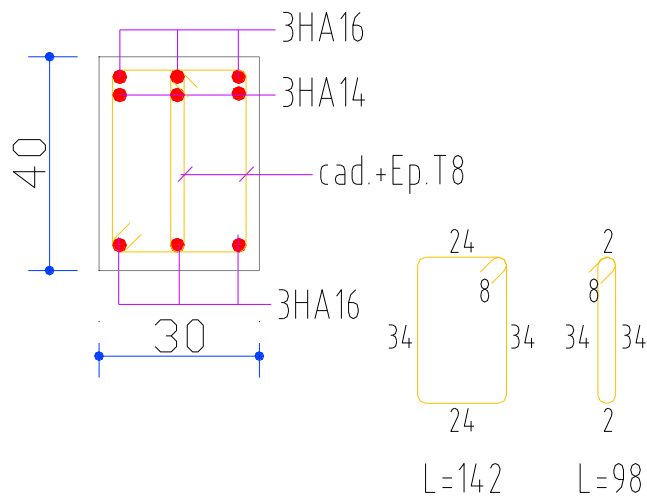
Ferrailage des poutres principales au niveau d'appuis de 1^{er} à 3^{ème} et de 8^{ème} à 13^{ème} étage.
